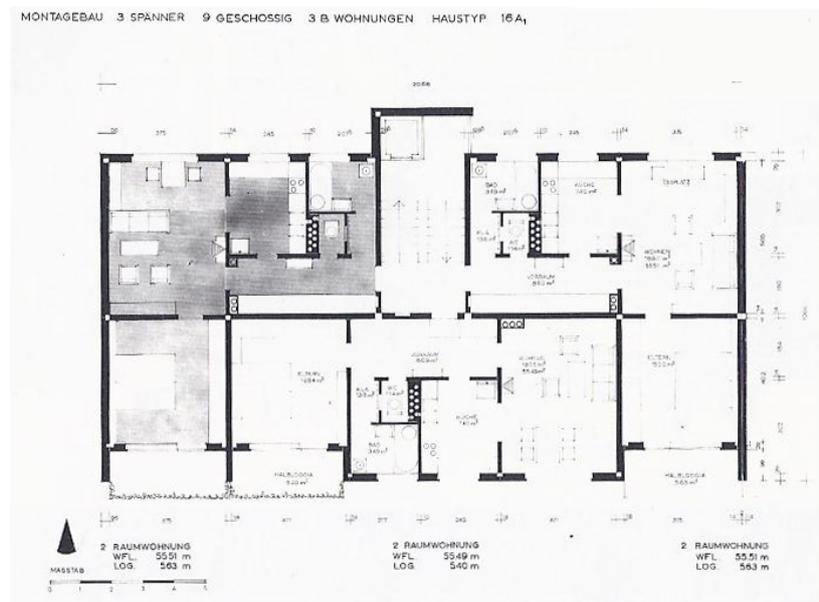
Wohnhausanlage Großfeldsiedlung, Regelgrundriss
